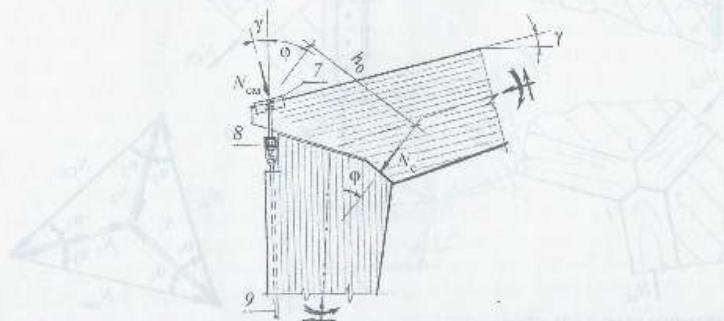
Расчетная схема жесткого узла по рис. 8.2, τ
